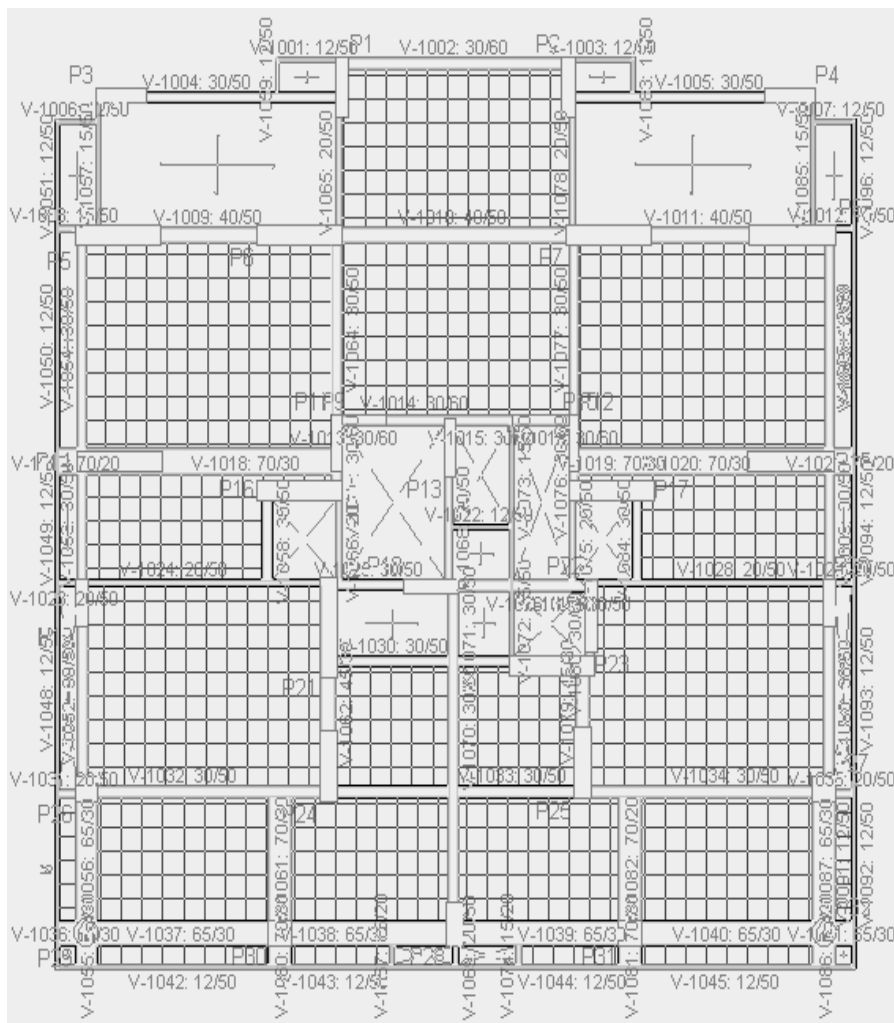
Laje lançada para cálculo. Fonte: Própria
